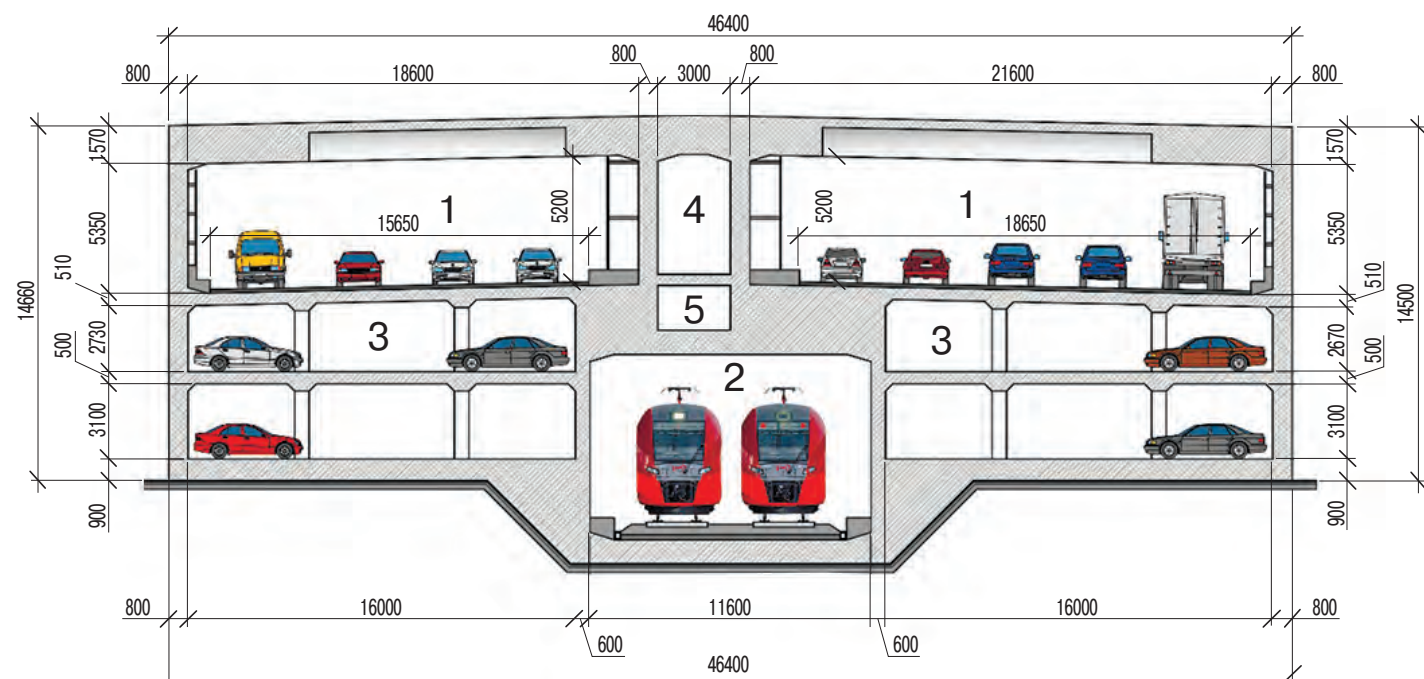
Поперечное сечение Гагаринского тоннеля в Москве: 1 – зона проезжей части автотранспортного тоннеля; 2 – железнодорожный тоннель МЦК; 3 – автомобильная парковка; 4 – вентиляционный канал; 5 – кабельный канал
